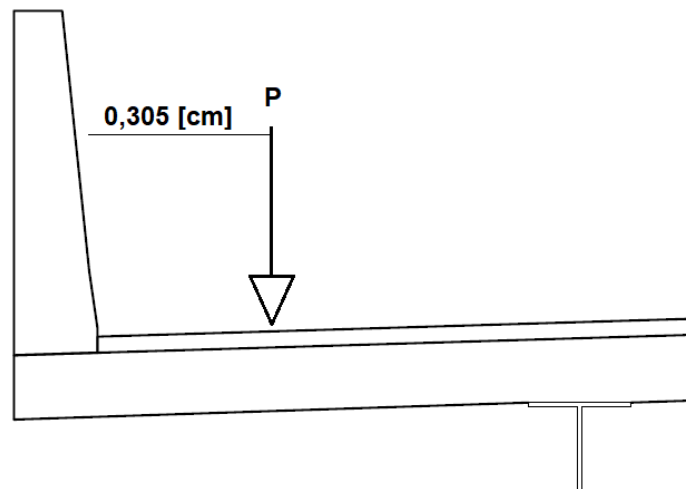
Caso eventual para cálculo de momento por carga móvil para tramos de losa en voladizo
